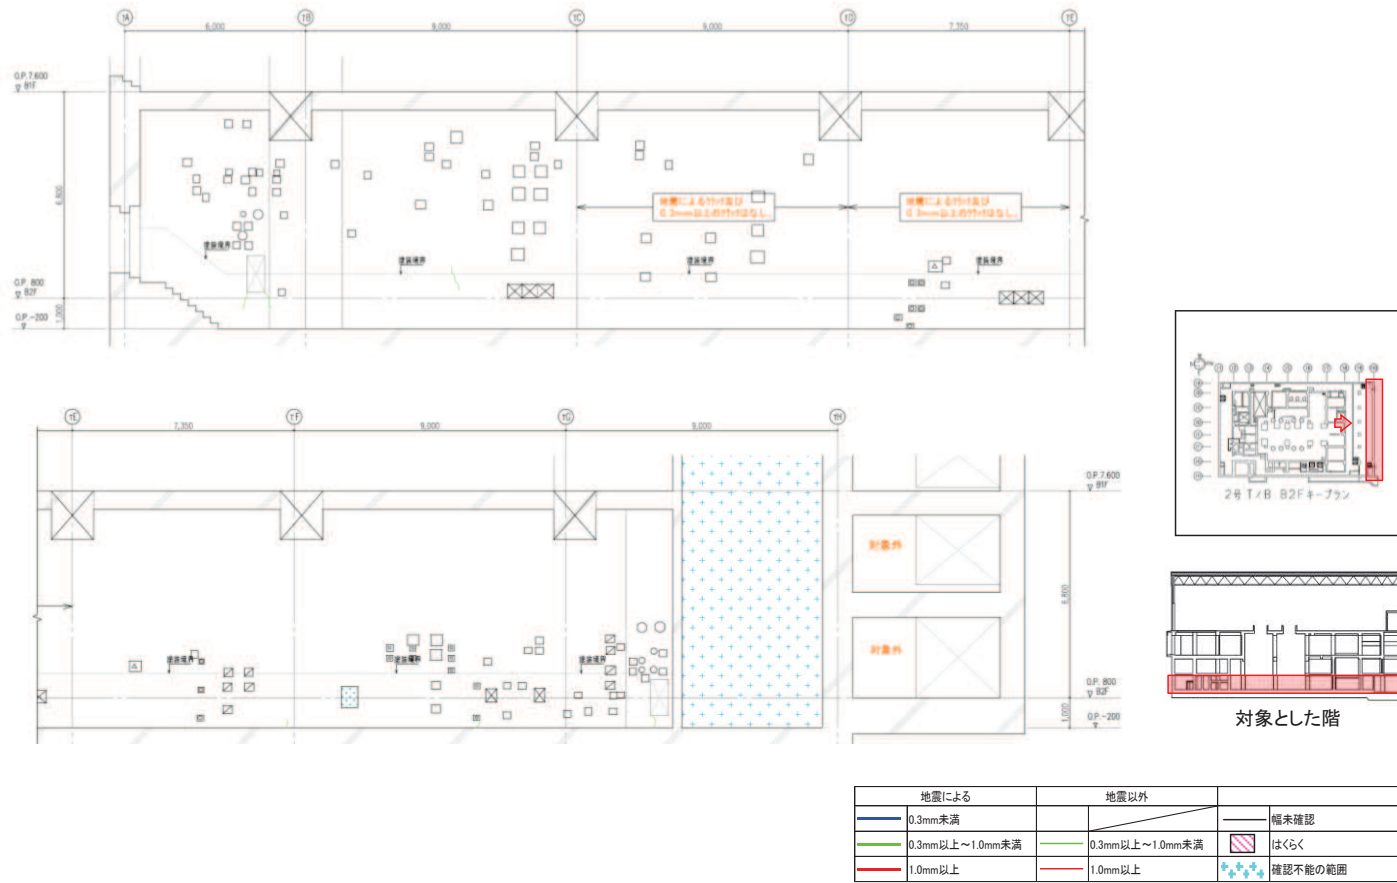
タービン建屋のひび割れ分布 耐震壁(9) 地下2階 T10 通り
